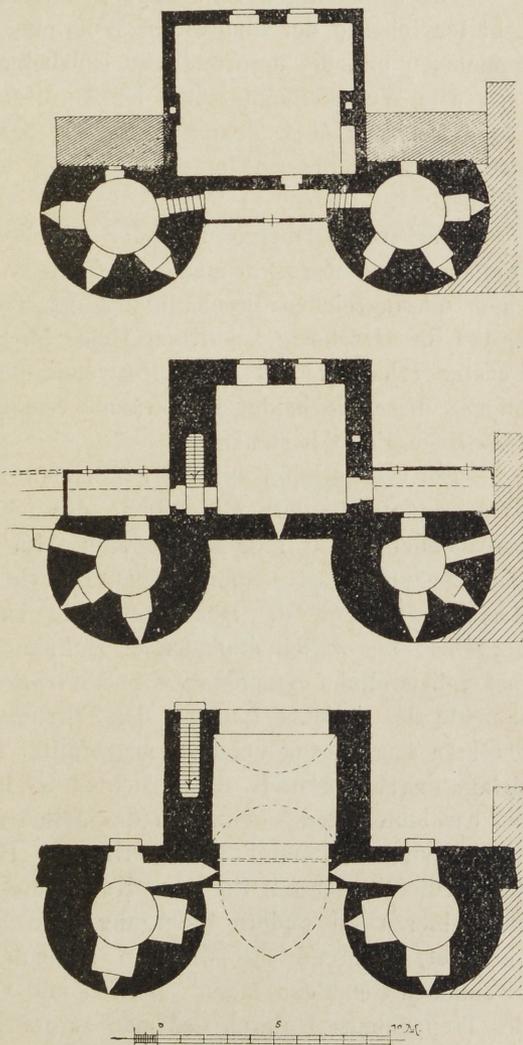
Jülich. Grundrisse des Rurttores.
